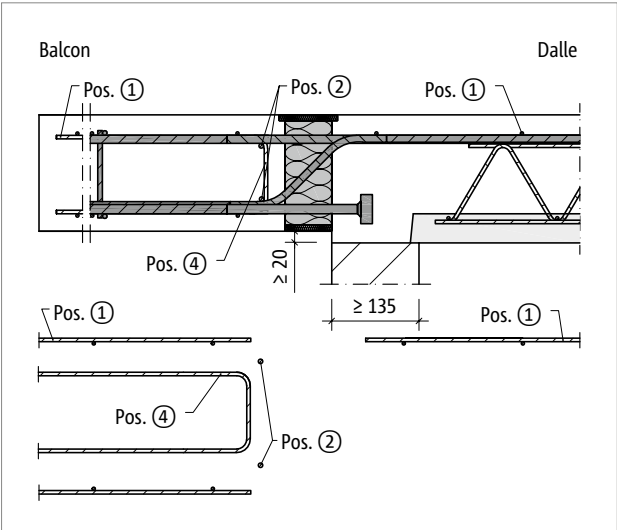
Schöck Isokorb® T type K-T-M13 : renforcement sur site pour support
